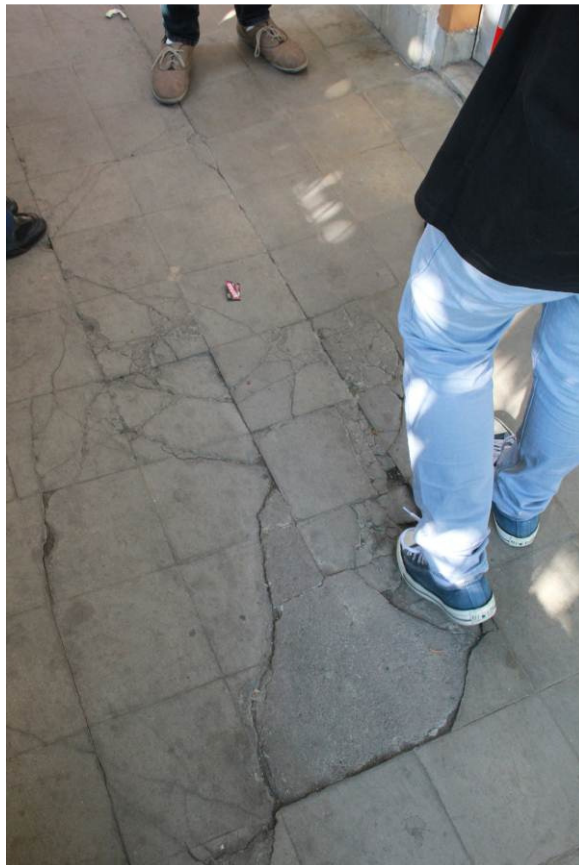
Foto Bangunan SMPLB A YPAB yang kurang aksesibel
